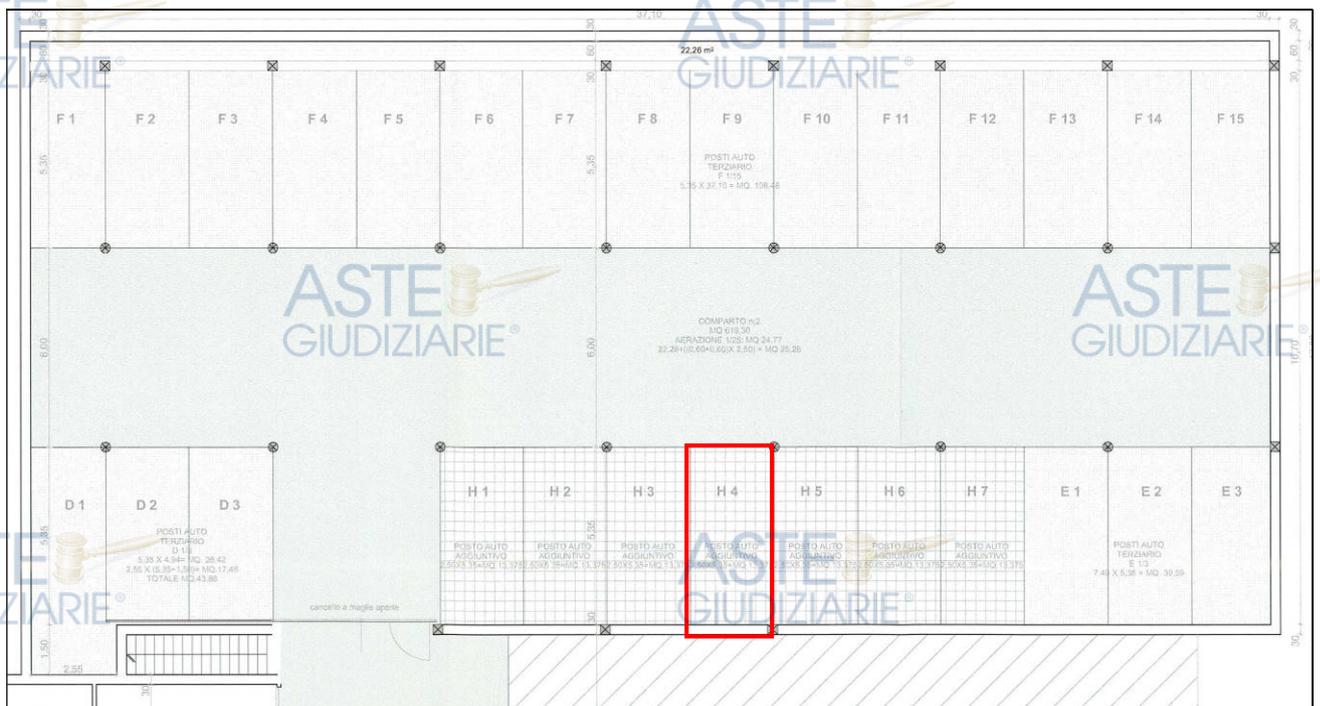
Estratto Tav. 03 pianta piano interrato D.I.A. Prot. 52454 del 05.12.2006 con indicazione dell’unità immobiliare in oggetto
